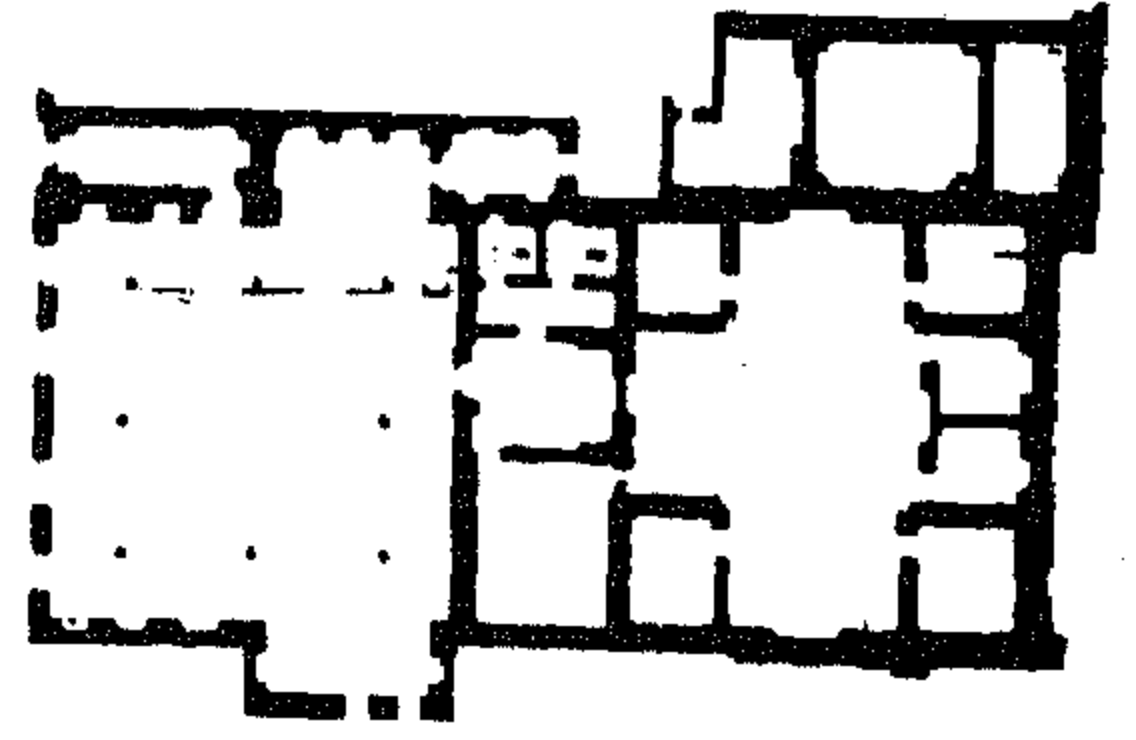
مسقط أفق لقصر الأخضر وحصنه
